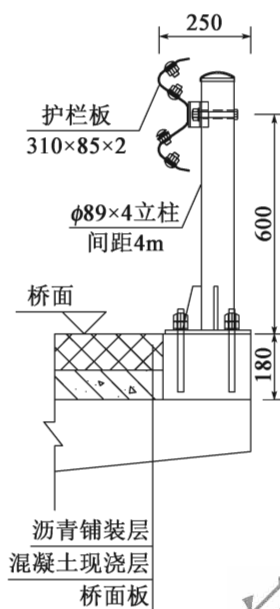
波形梁护栏横断面布置(尺寸单位: mm)
